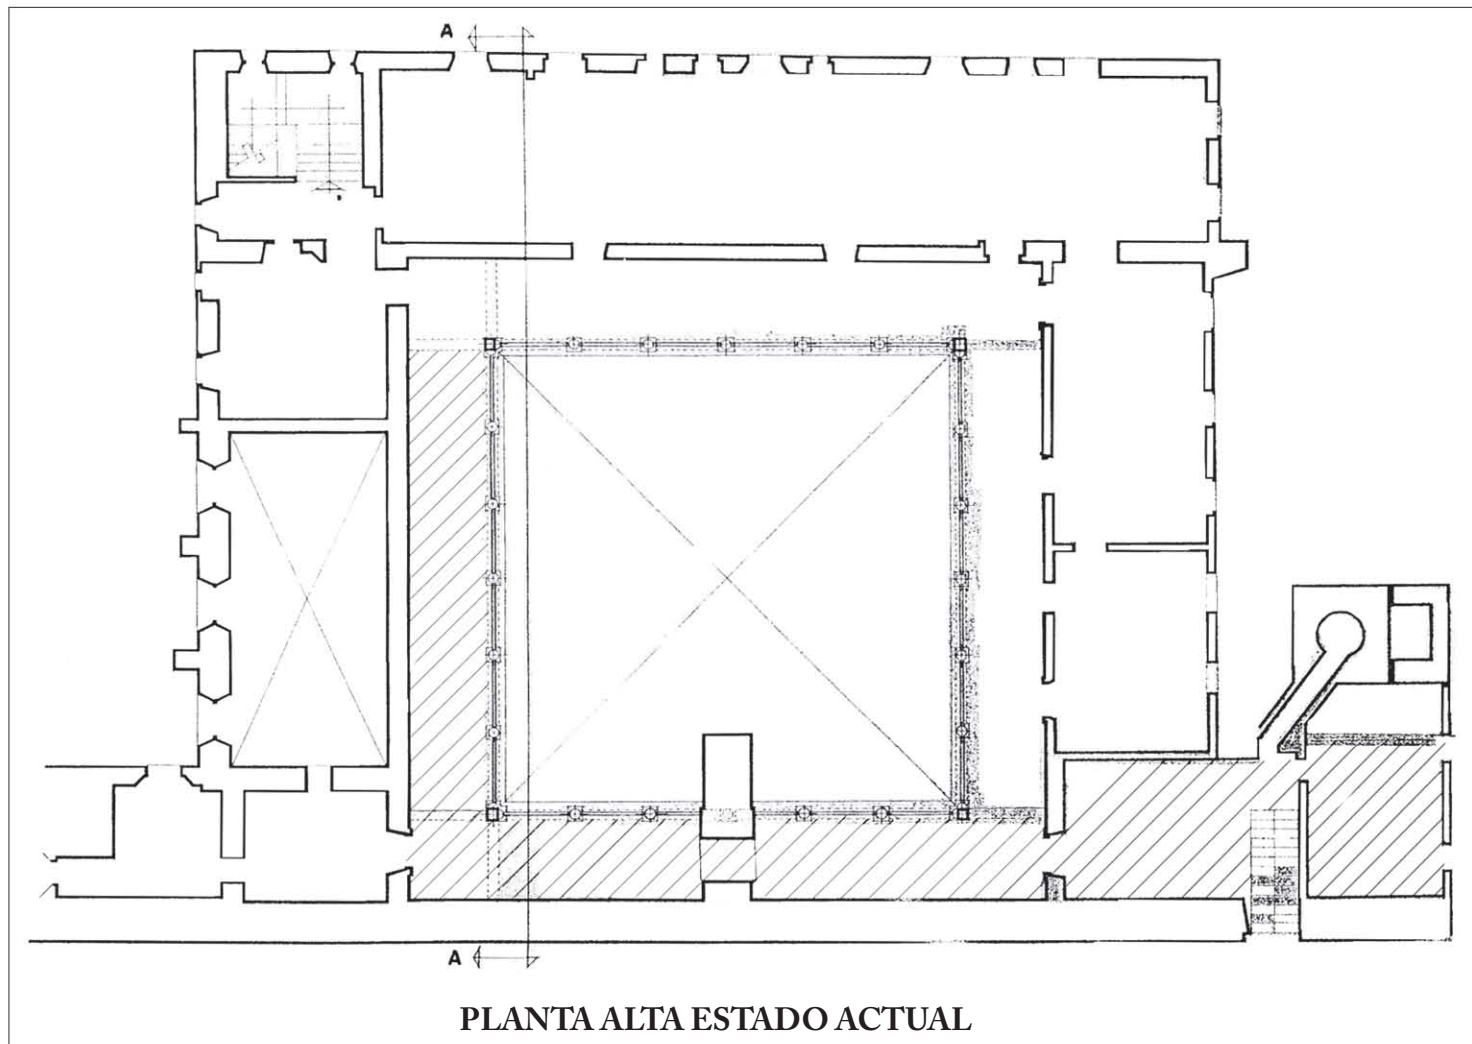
Levantamiento, planta alta del estado actual. Archivo geográfico, INAH, CNMH; *San Bernardino de Siena, templo y ex convento*, Col. Santa Crucita Barrio, Delegación Xochimilco, DF, Planoteca.
